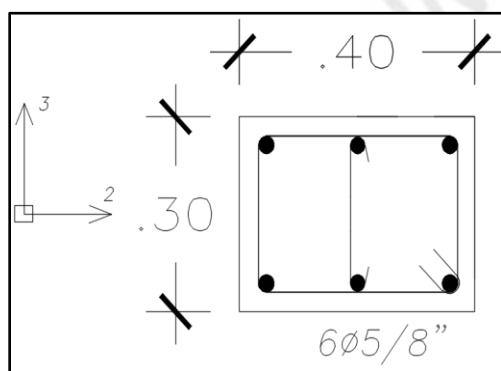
Detalle de refuerzo longitudinal a flexocompresión de la columna C-3.
